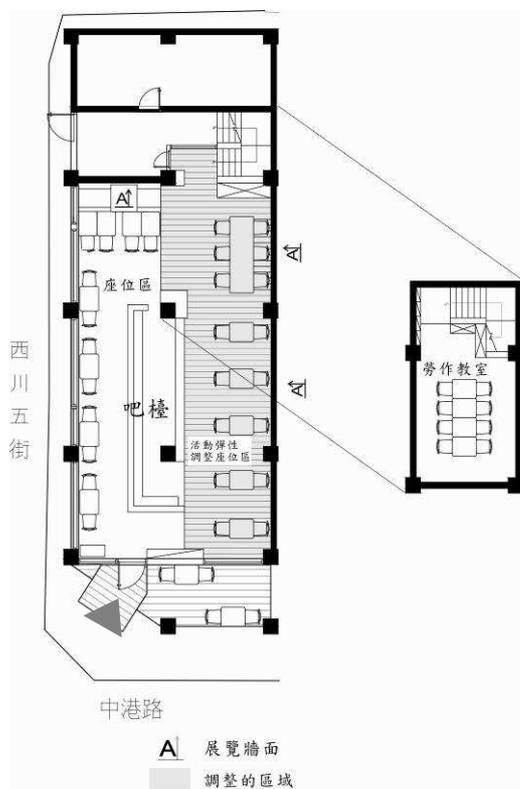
新默契咖啡館平面 左：1F 平面圖 右：B1 平面圖
